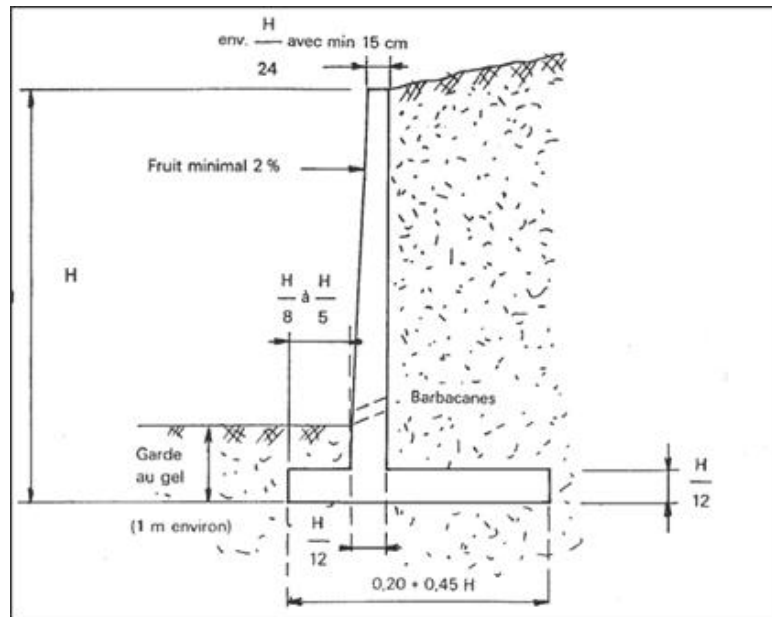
Coupe en travers du mur de soutènement avec prédimensionnement
